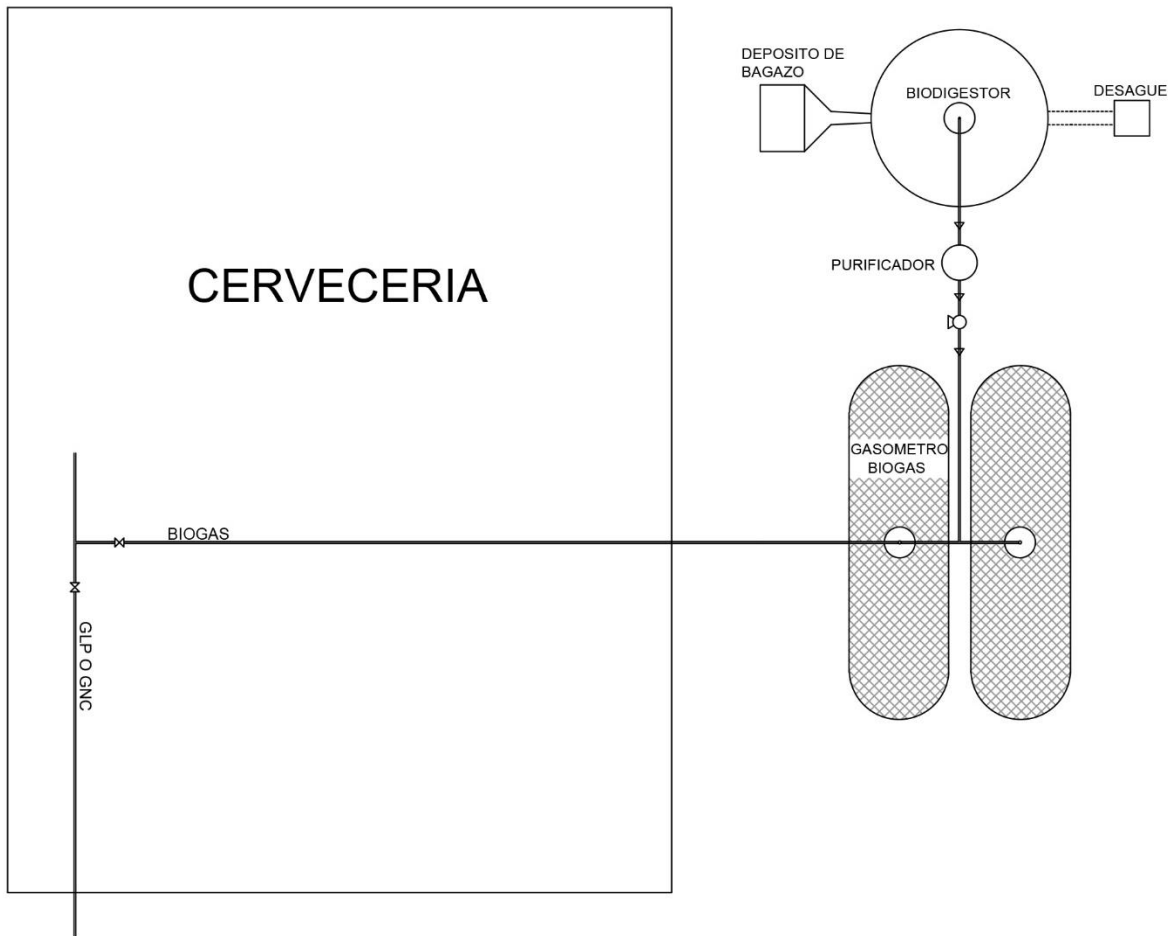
Sistema de biogás a implementar en la cervecería artesanal modelo, vista planta.
